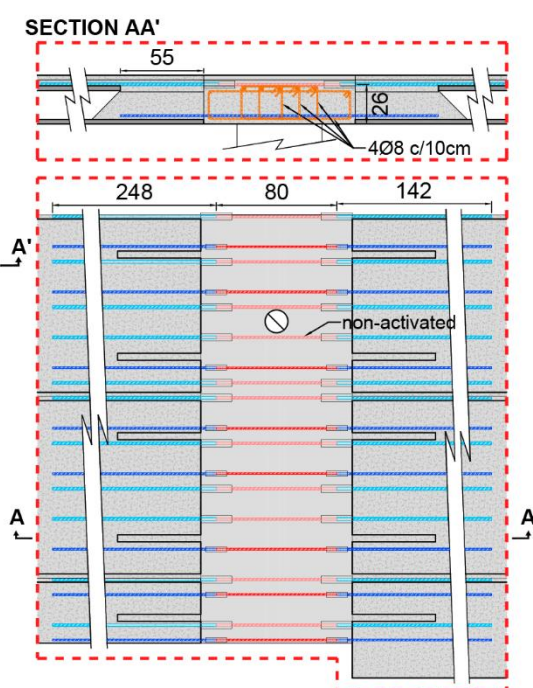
Geometría general y detalle refuerzo a negativo. Cotas en cm.
